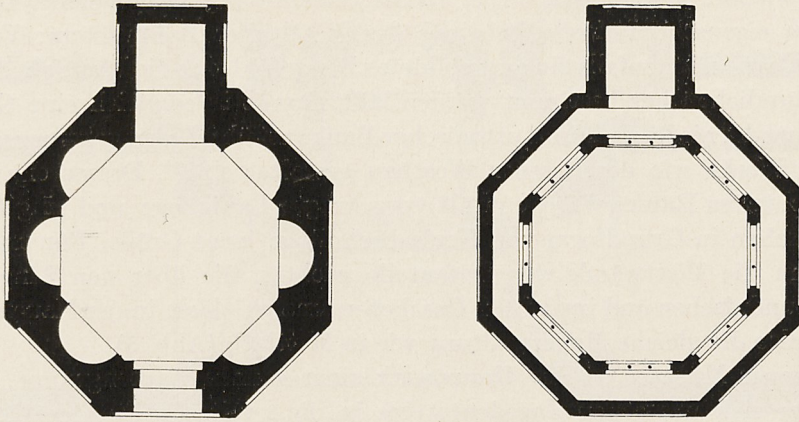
Mettlach, Alter Turm, ergänzte Grundrisse beider Geschosse.
